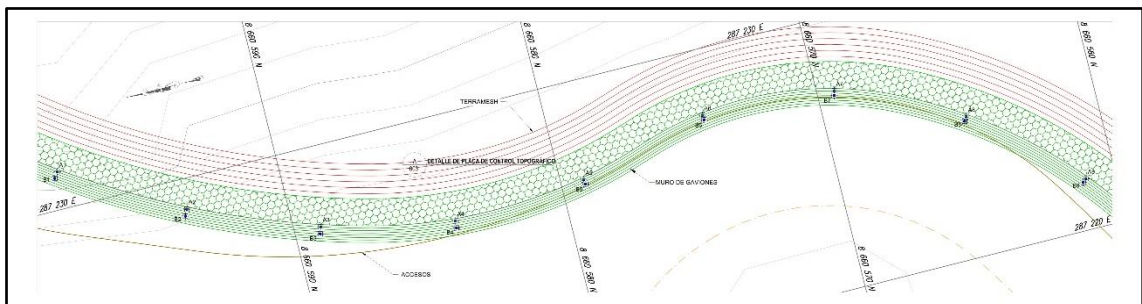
Vista plano en planta de la instalación de las placas de control topográfico.
